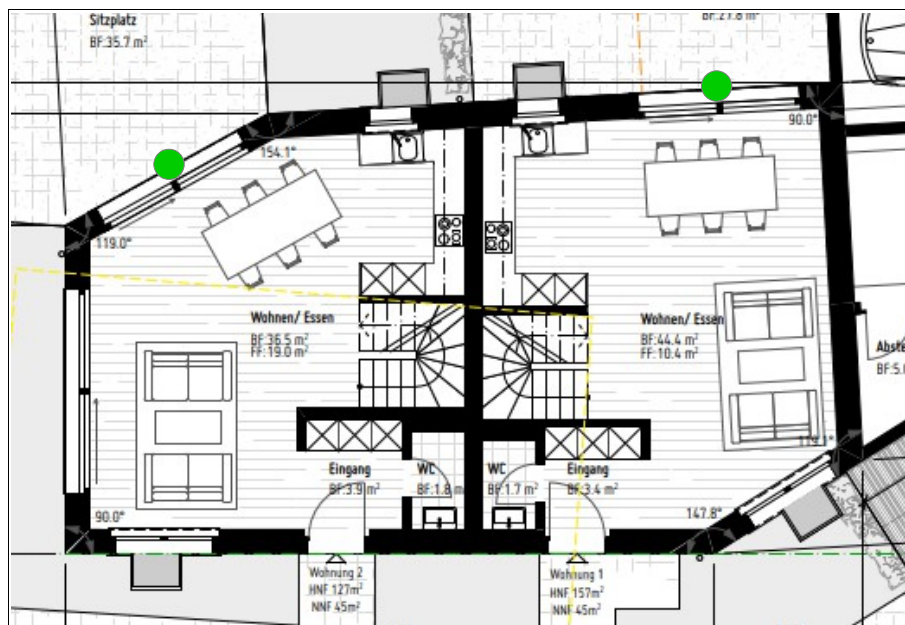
Grundriss EG, ohne Mst.; Quelle: Auftraggeber
